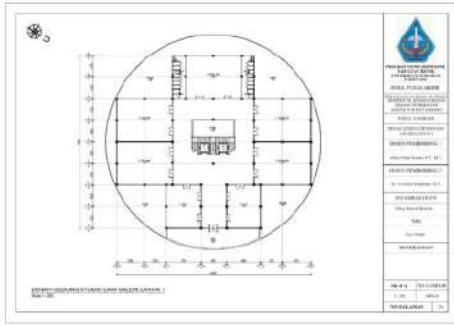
Denah Gedung Fak. Desain Lantai 2
